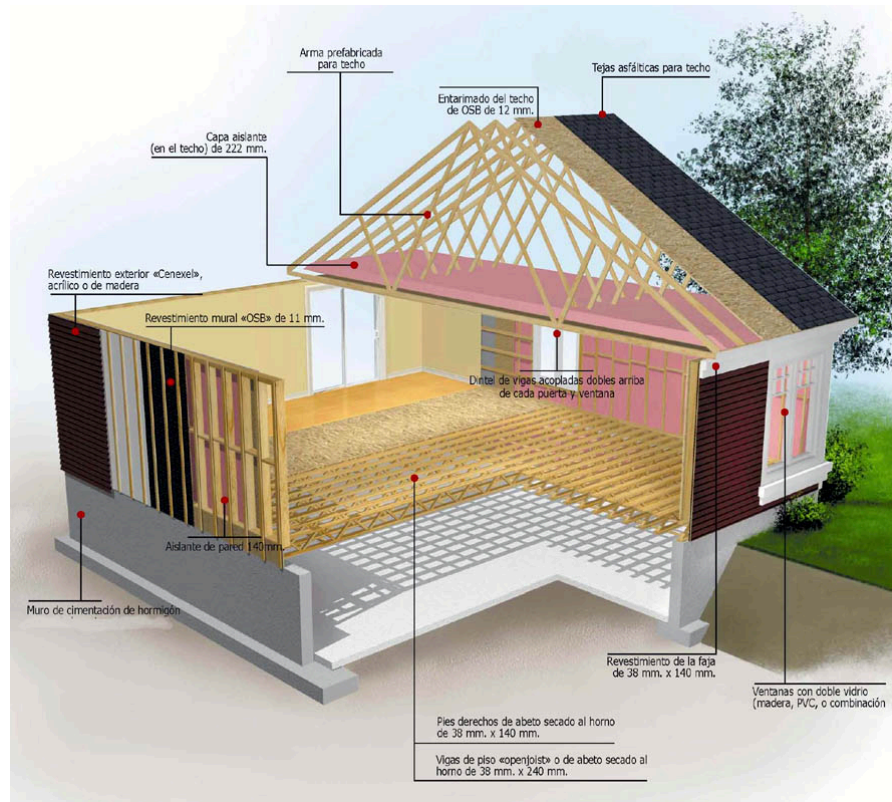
Casas de madera, sección de estructura y cubierta Sistema Everton.
